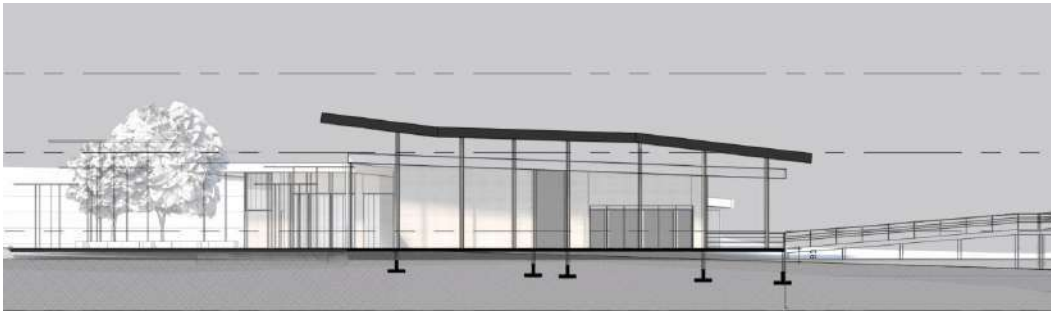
, Ampliación de corte de sección de la edificación, por el autor.
